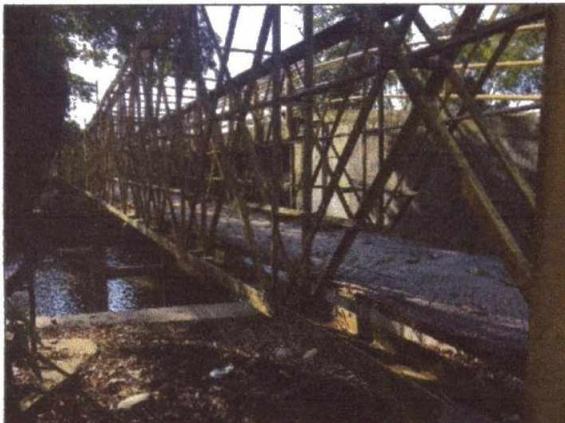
DETALLE VIGAS METÁLICAS CUADRADAS
